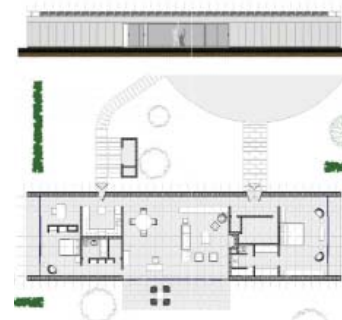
Residência do arquiteto, 1963, East Hampton, New York. Arquiteto: Gordon Bunshaft. Planta baixa e fachada sul.
